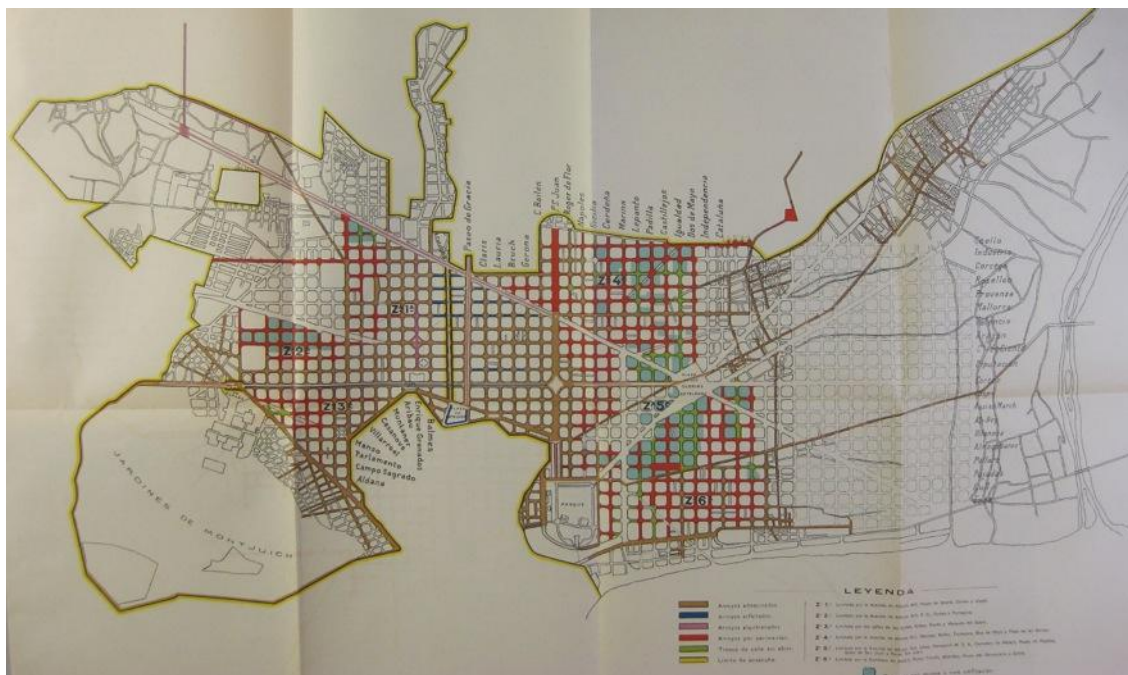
> Proyecto de pavimentación del Ensanche de 1927, En color azul vemos las calles que se asfaltarán, los adoquines retirados de estas calles se utilizan para pavimentar otras calles prioritarias (Comisión de Ensanche 1927)
